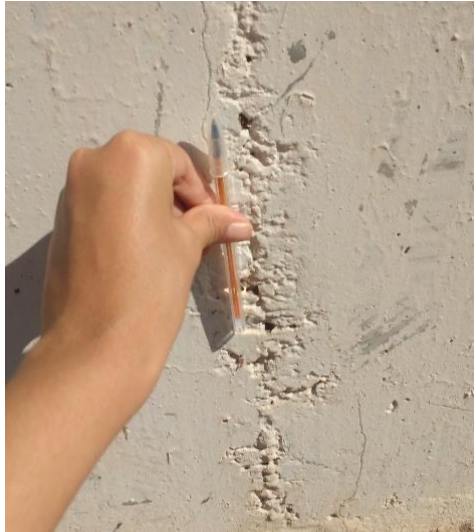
Fissuras mapeadas presentes em toda a extensão das barreiras *New Jersey
